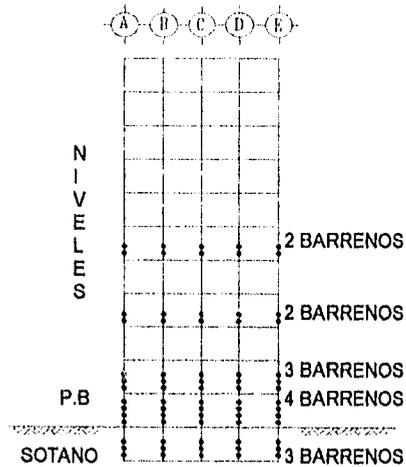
III NUMERO DE NIVELES A PREPARAR Y CANTIDAD DE BARRENOS EN CADA COLUMNA.
